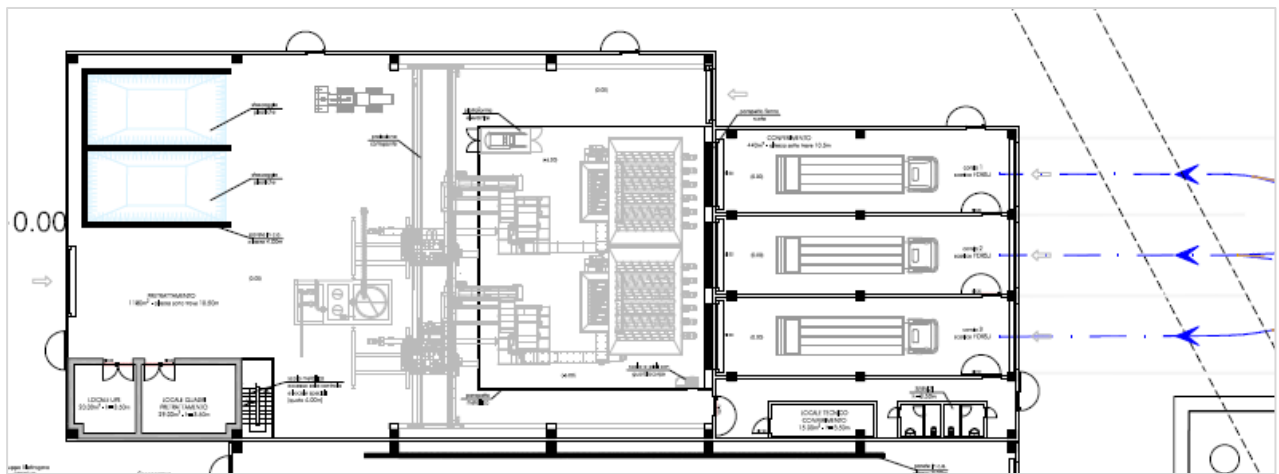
Aree conferimento e pre-trattamento_ Stralcio dalla planimetria generale
